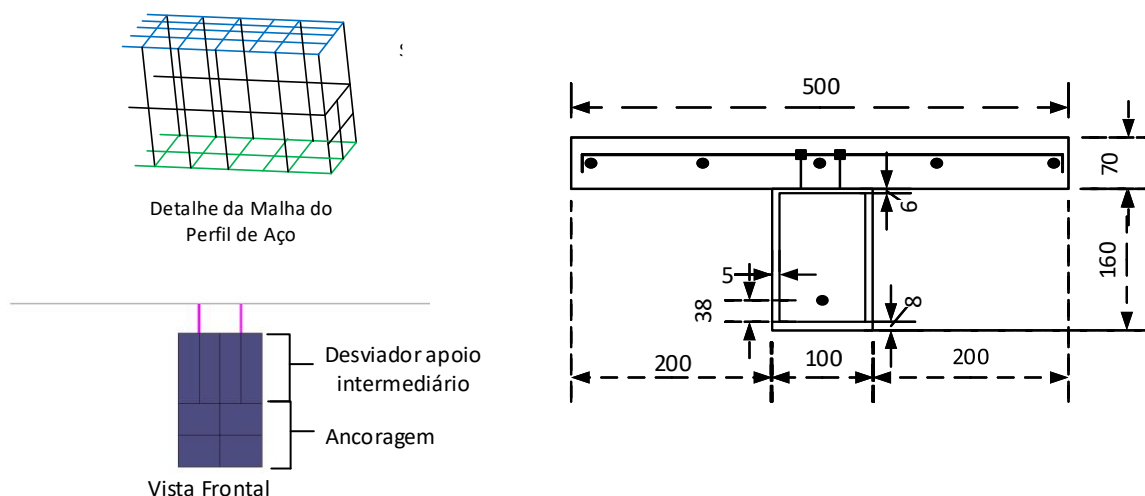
Malha de elementos finitos e detalhe da posição do cabo para viga PCCB1 (mm)
